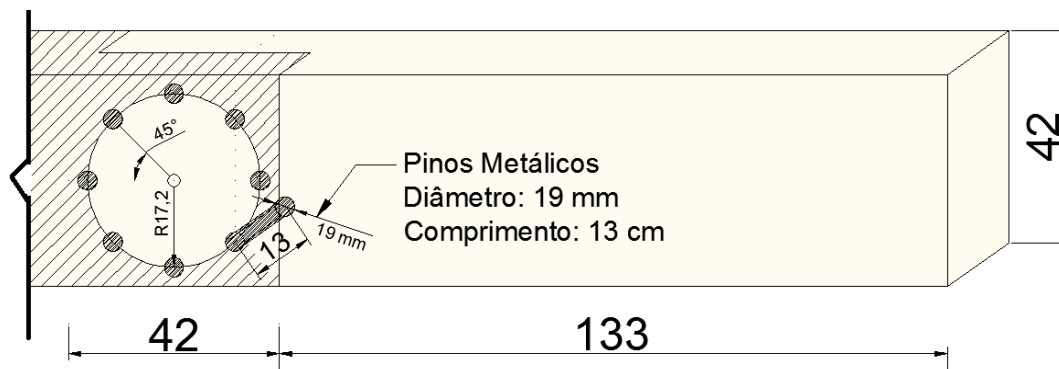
Detalhe do layout para preparação da emenda e ligações. Dimensões em centímetros.
